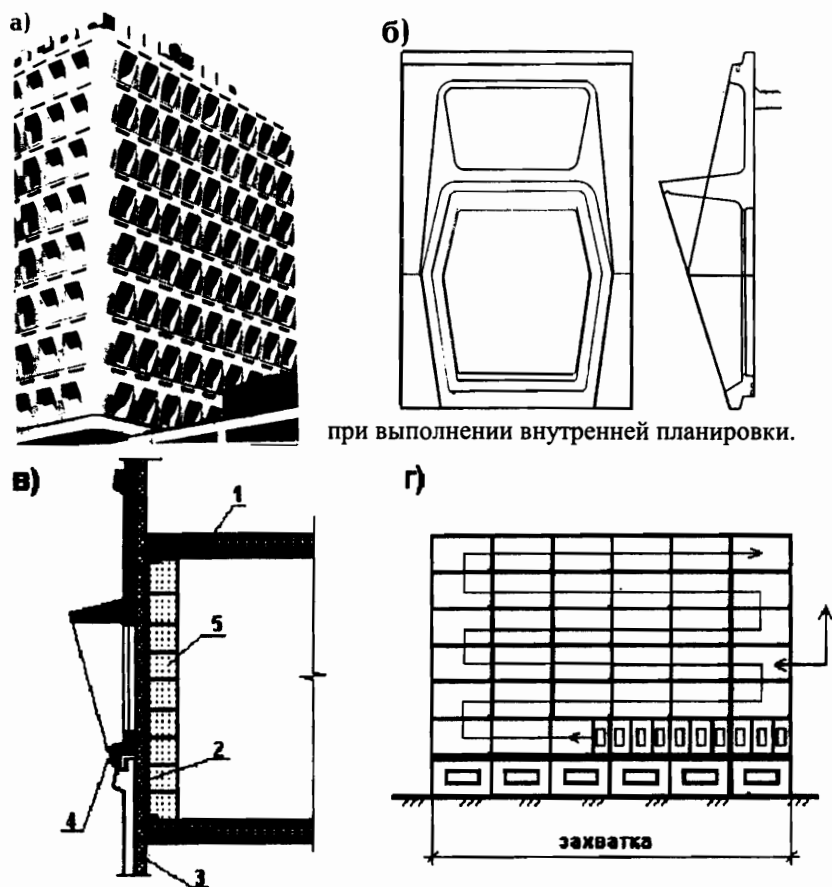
Технология устройства фасадов с применением облицовочных панелей из архитектурного бетона: а - общий вид фасада; б - конструктивное решение облицовочной панели; в - конструктивное решение ограждающей конструкции; г - технологическая последовательность монтажа облицовочных плит: 1 - плита перекрытия; 2 - металлическая стойка; 3 - утеплитель; 4 - облицовочная панель
